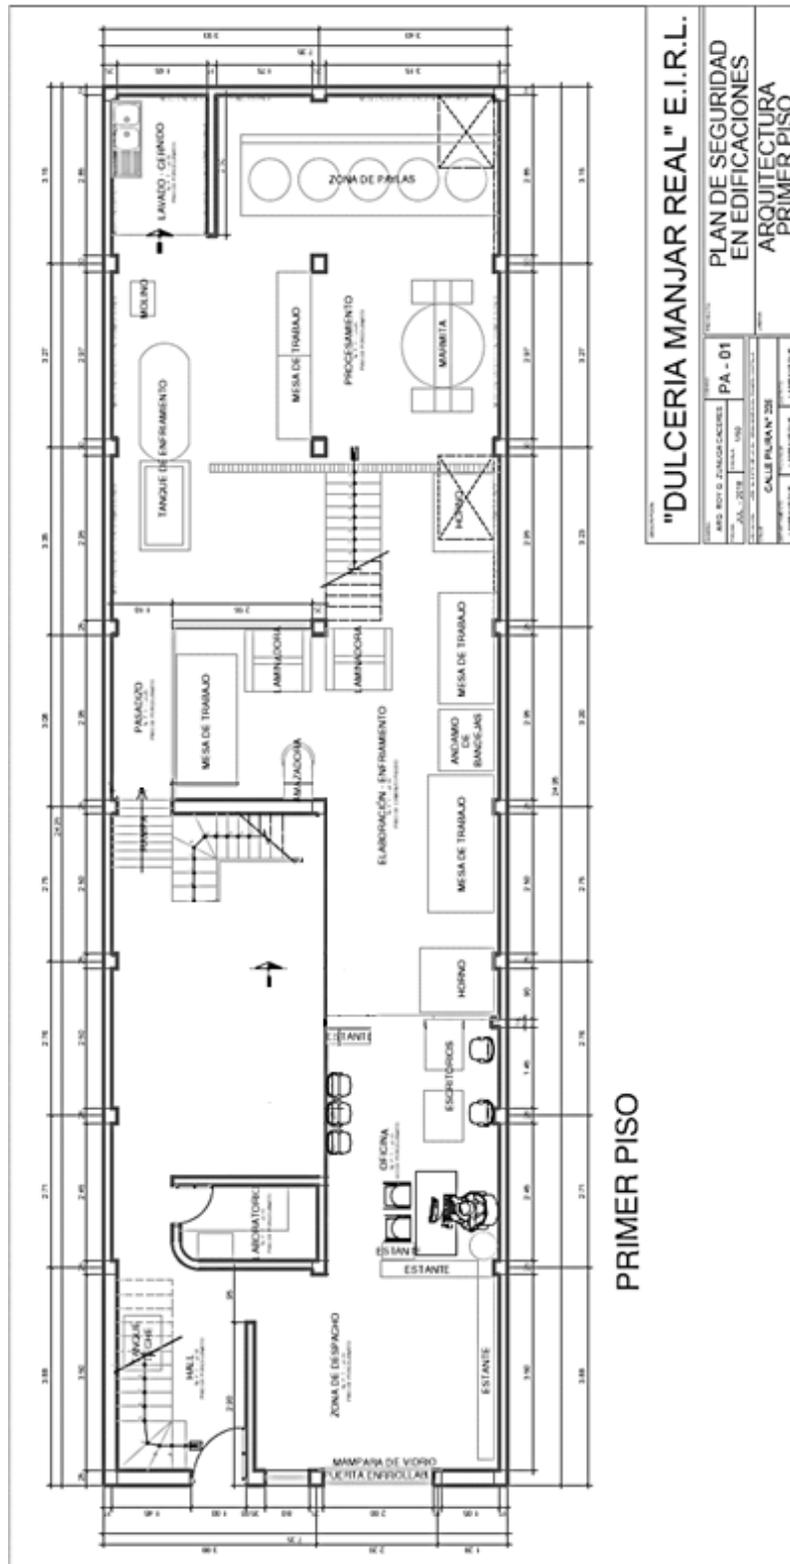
Plano de Dulcería Manjar Real E.I.R.L – Primer Piso.
